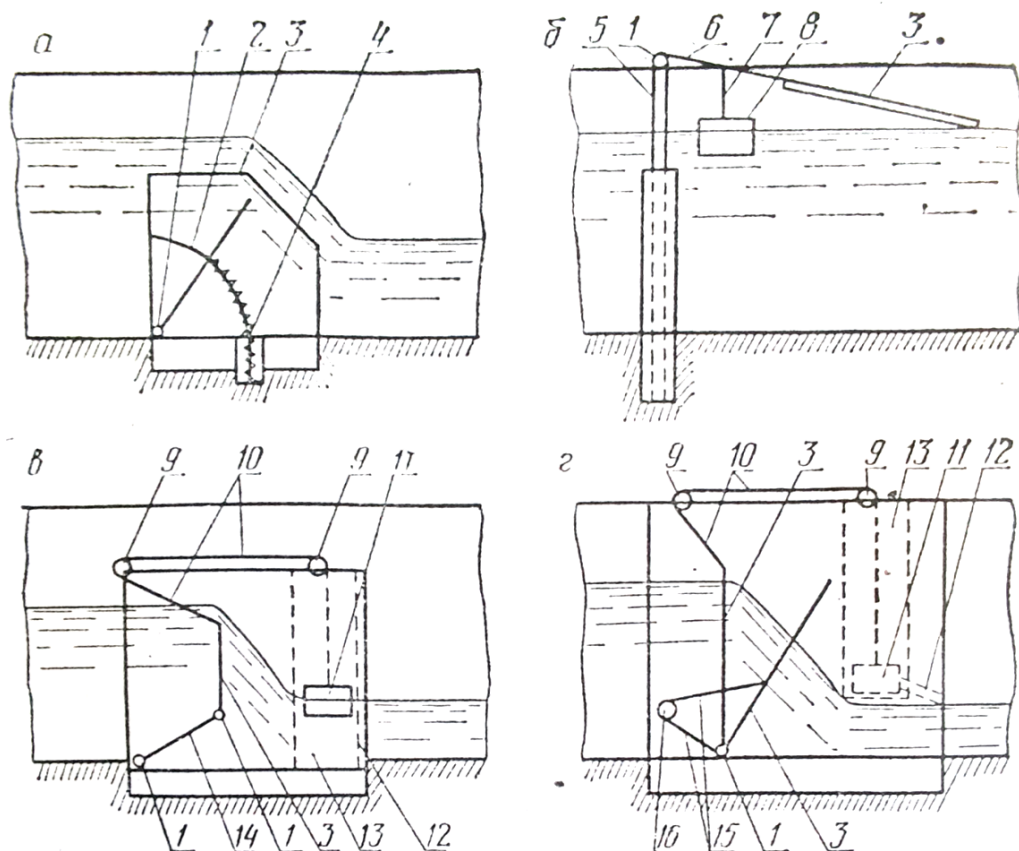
Схемы водопроводных сооружений со сквозными щитами: 1 – ось щита; 2 – направляющая пружина; 3 – щит с прорезями-щелями; 4 – пружина; 5 – опоры; 6 – рычаги; 7 – ось поплавка; 8 – поплавок; 9 – блоки; 10 – трос; 11 – противовес-поплавок; 12 – подпитывающая труба; 13 – колодец; 14 – сплошной щит; 15 – консоли; 16 – груз-балансир.
